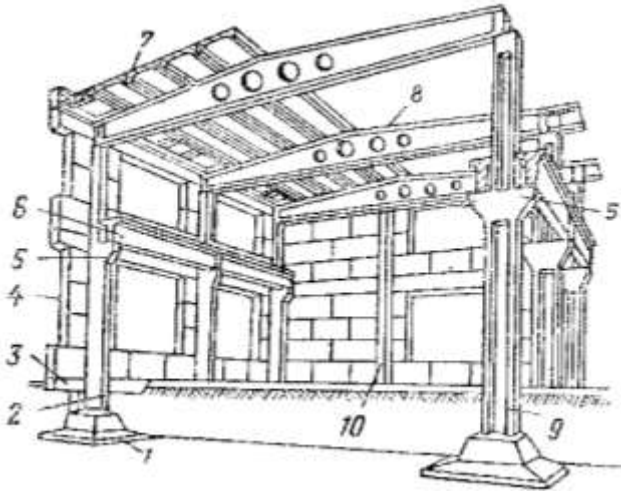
Фрагмент одноповерхової промислової будівлі: 1 – фундамент; 2 – колона крайнього ряду; 3 – фундаментна балка; 4 – стінова панель; 5 – консоль колони; 6 – підкранова балка; 7 – панель покриття; 8 – балка покриття; 9 – колона середнього ряду; 10 – колона торцевого фахверку
